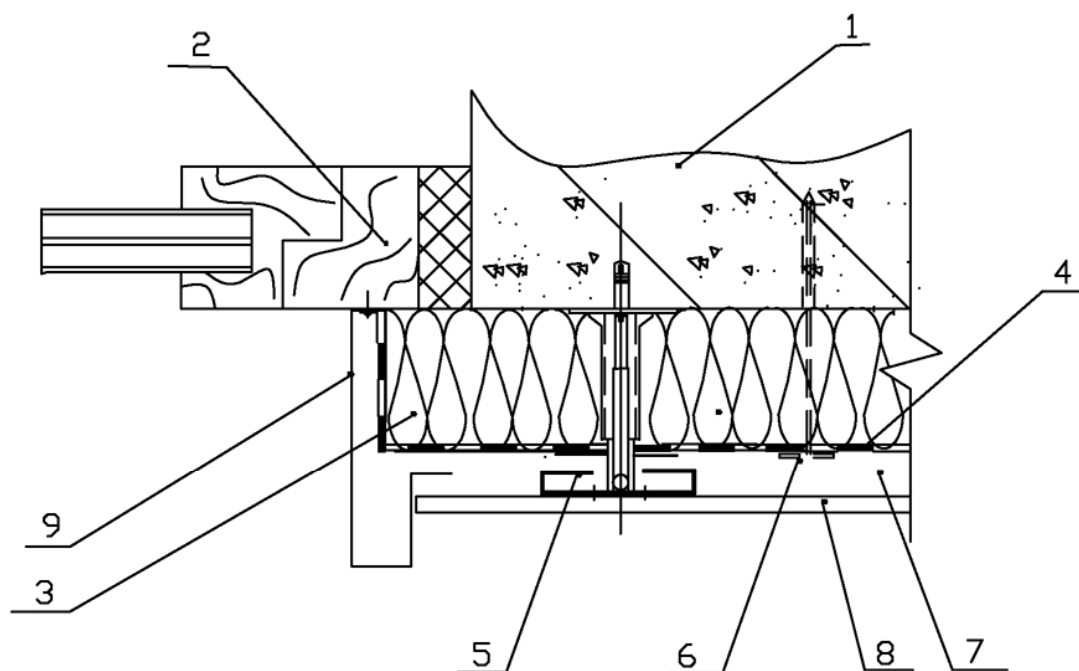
Стык с подоконным отливом при утеплении стены теплоизоляционными плитами ИЗОРОК в один слой
